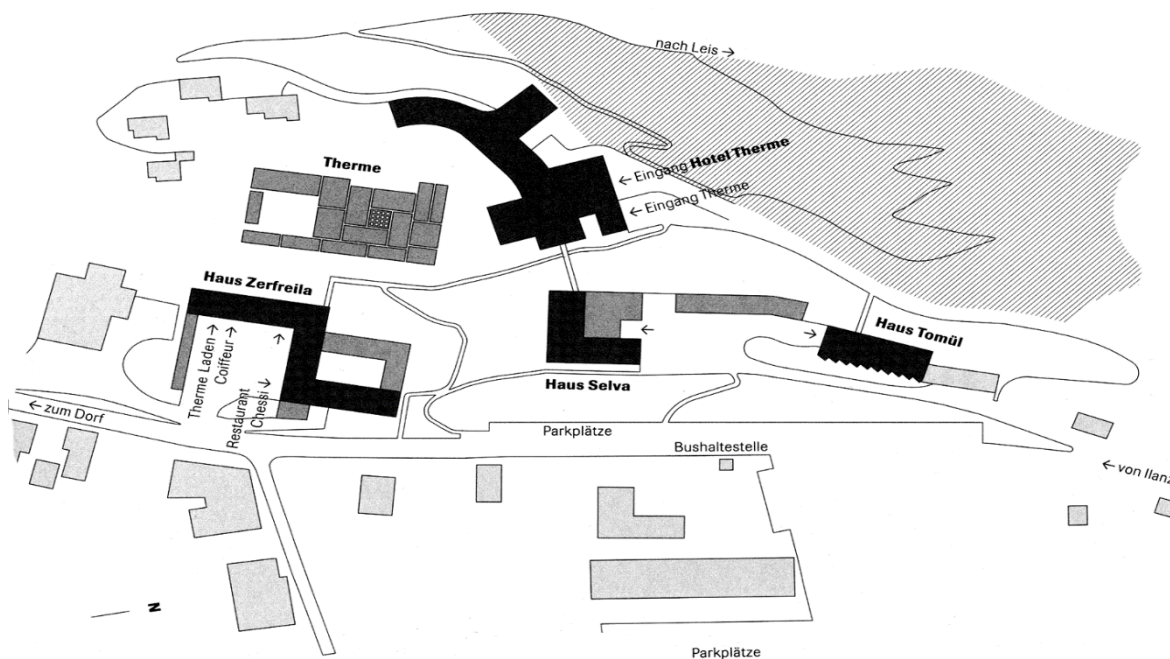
Planta de Implantação (The Therme Vals). (Portuguese Architecture, 2014b)
